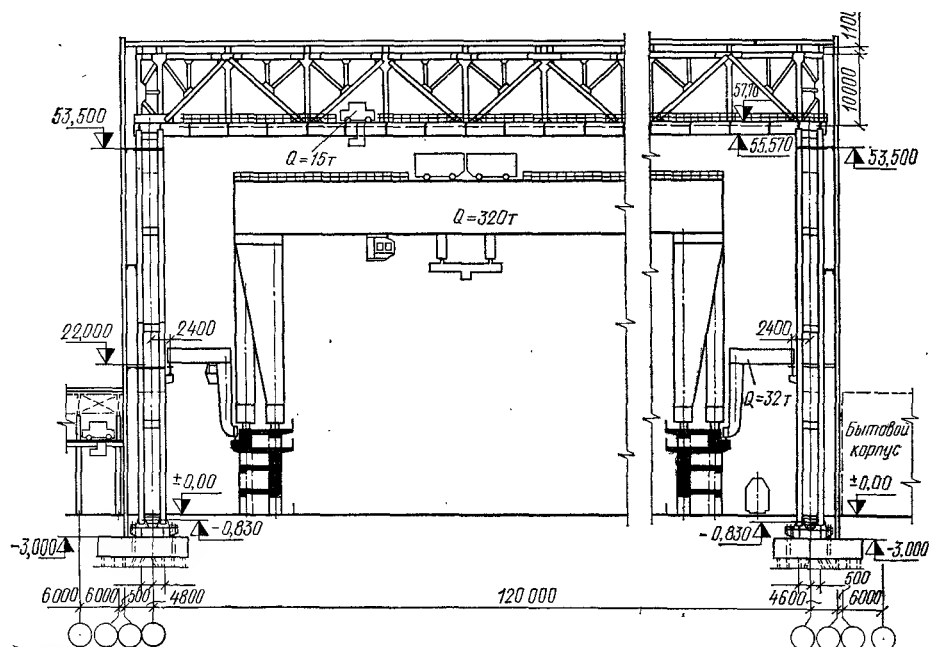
Поперечный разрез сборочного цеха пролетом 120 м
